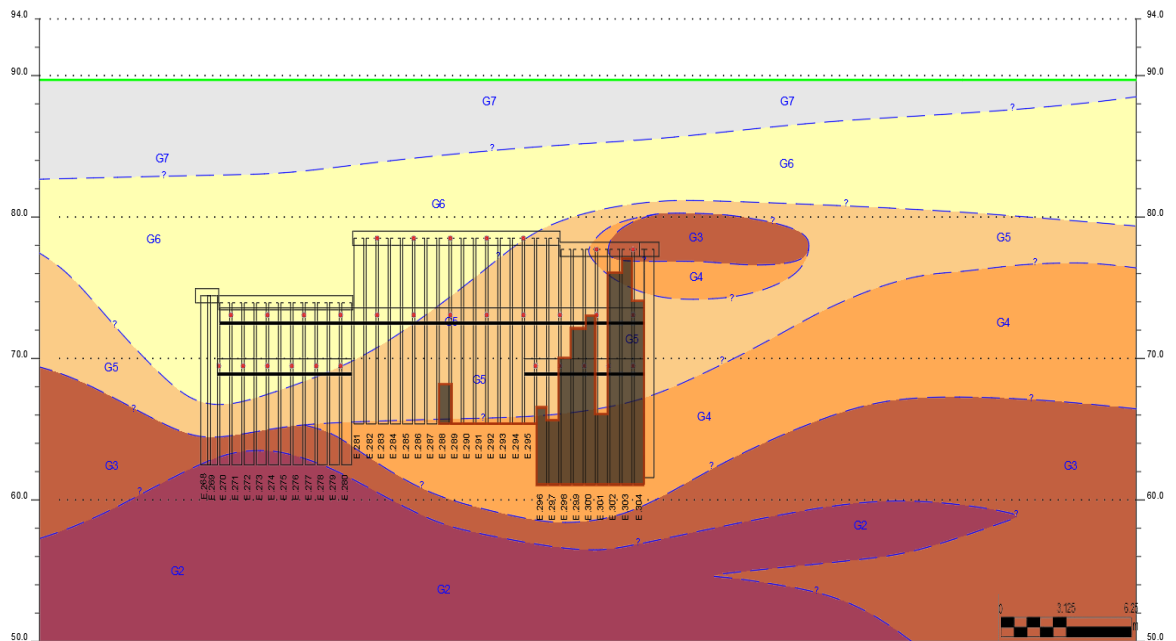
Intervalos de utilização do caroutier em estacas de Ø800 mm no perfil transversal geotécnico CT02 (alçado 18).
